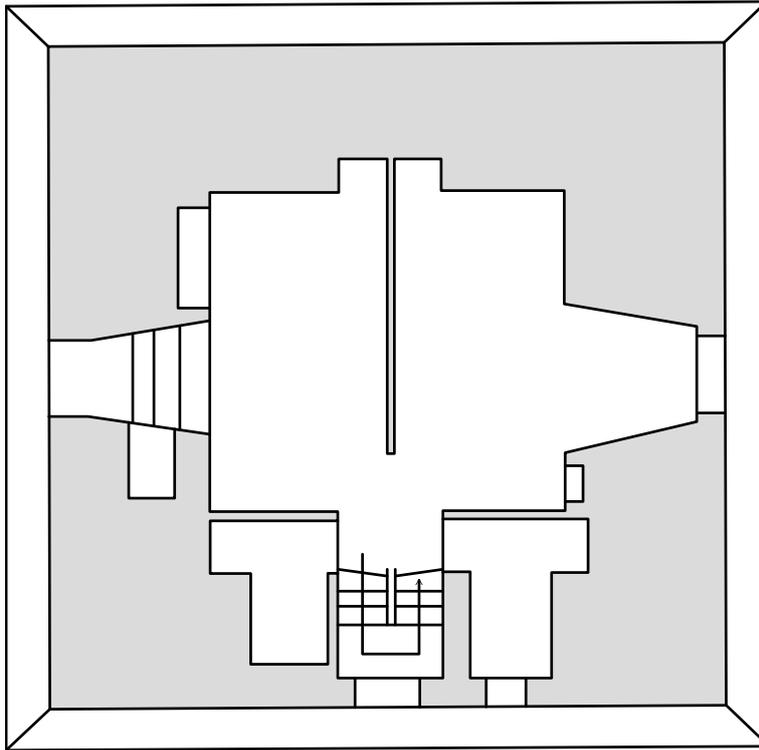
Torre Sabea, pianta del piano primo (rielaborazione grafica).
